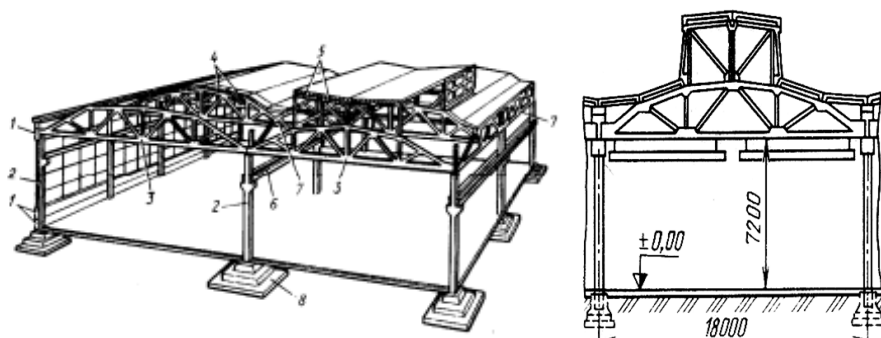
Конструктивні схеми та поперечний розріз прогонів одноповерхових виробничих будівель
